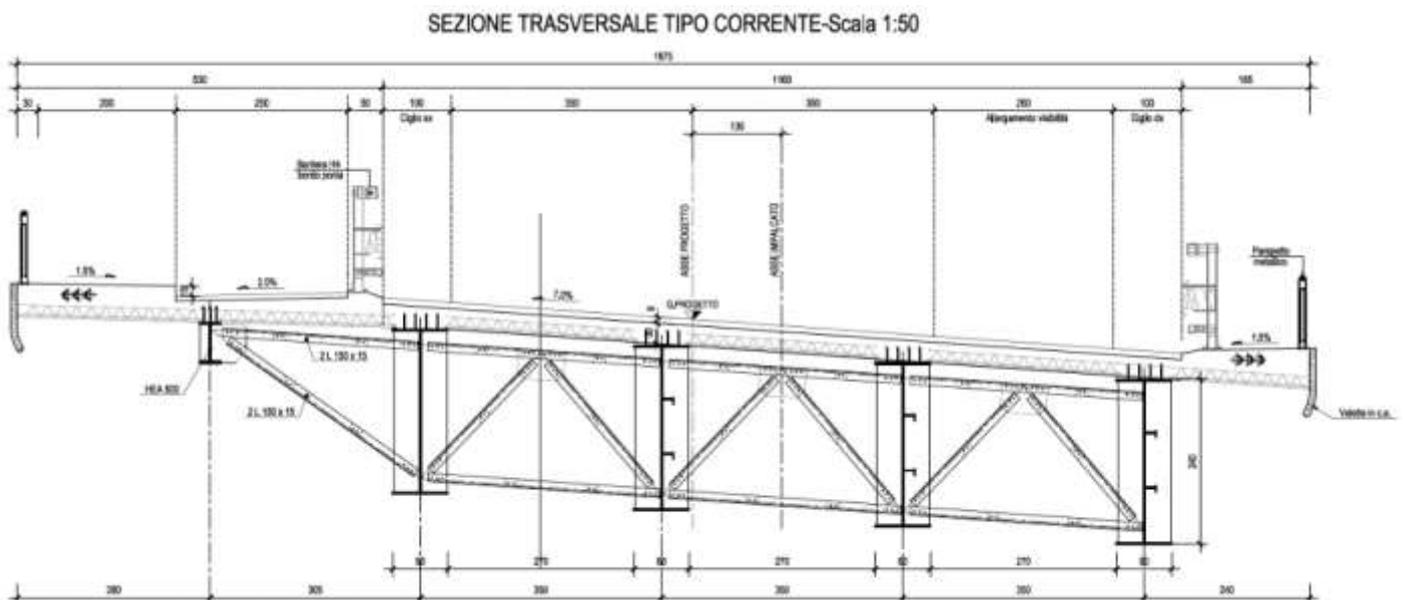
SEZIONE TRASVERSALE PROGETTO DEFINITIVO
